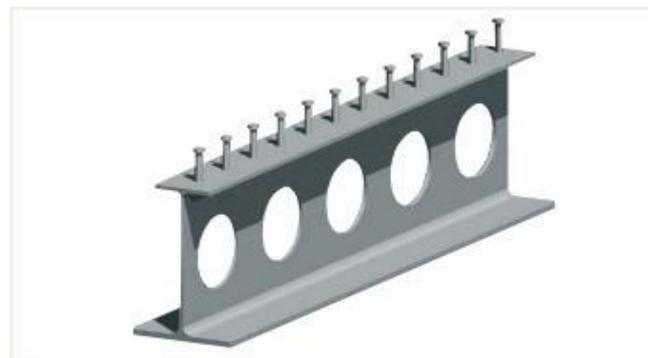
schéma présentatif d'un plancher collaborant/source : <http://detailsconstructifs.cype.fr>
